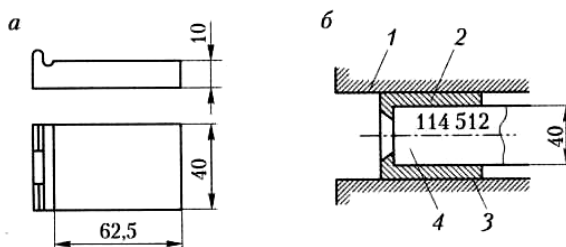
Пластины для передачи нагрузки на половинки образцов-балочек (а) и схема расположения образца между ними при испытании на сжатие (б): 1 - верхняя плита прессы; 2 - пластины; 3 - нижняя плита прессы; 4 - половинка образца-балочки
